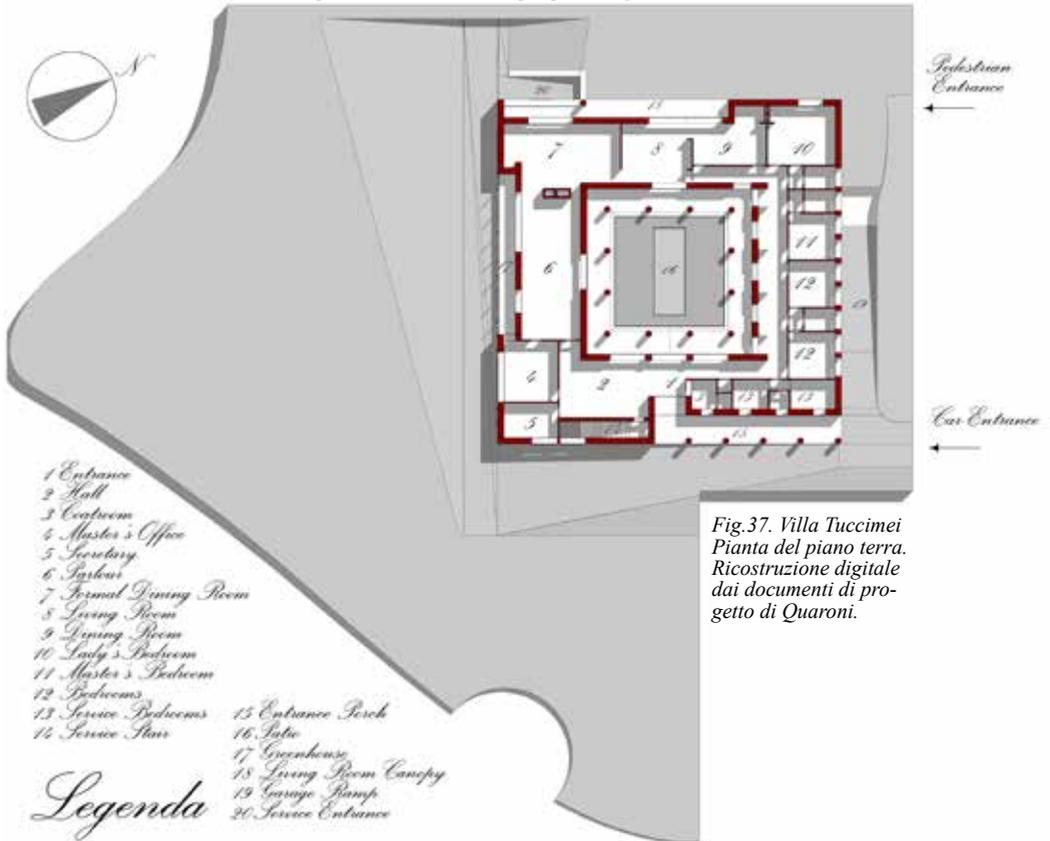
Villa Tuccimei Pianta del piano terra. Ricostruzione digitale dai documenti di progetto di Quaroni.
